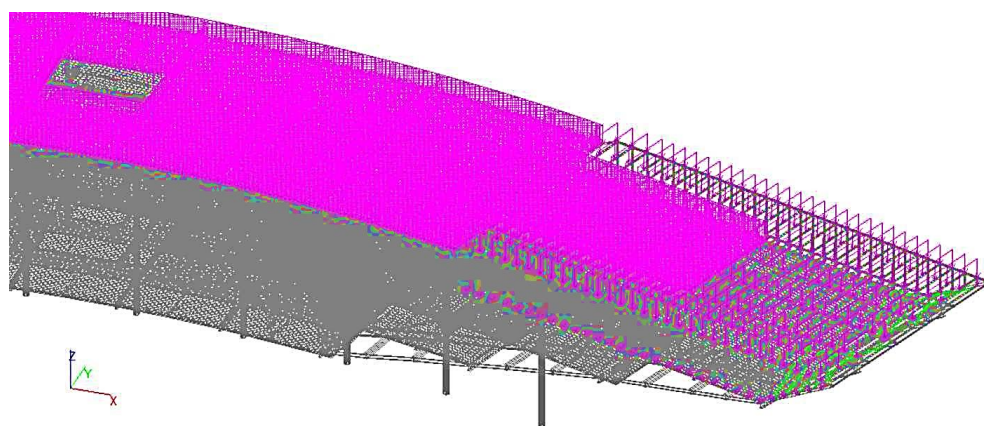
Снігове навантаження (фрагмент будівлі)
